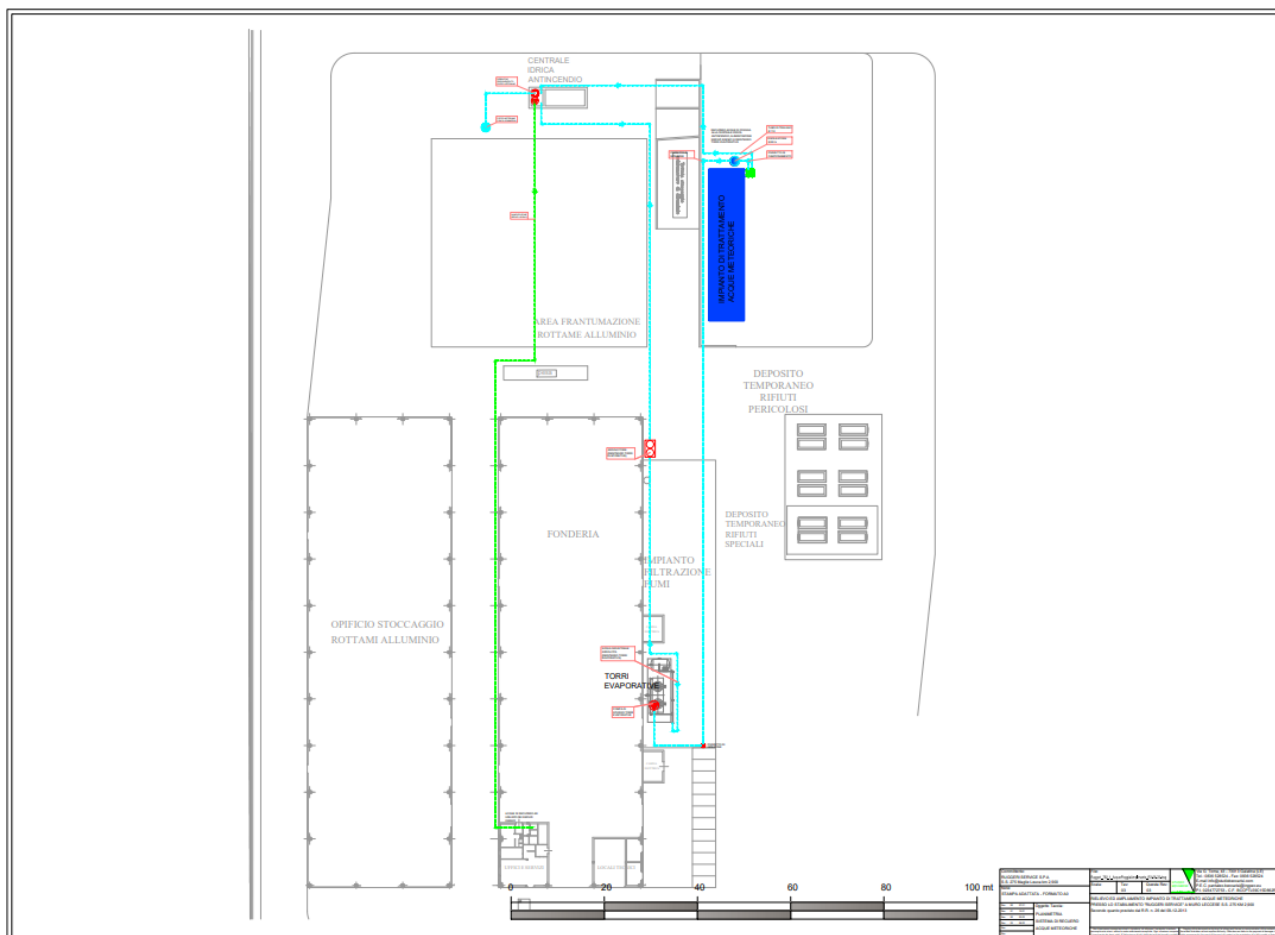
Planimetria sistema di recupero acque meteoriche
